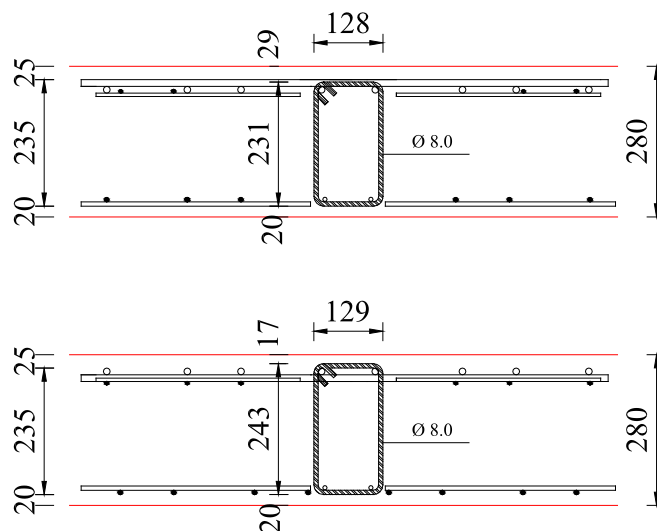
Detalhe da armadura de cisalhamento na laje SS1 (duas direções ortogonais, cotas em mm)
